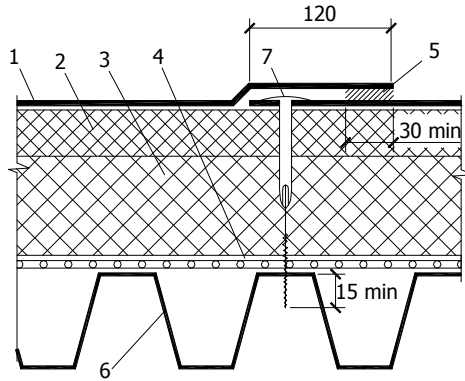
Схема крепления ПВХ-мембран и утеплителя к несущей конструкции из стального профилированного настила:
